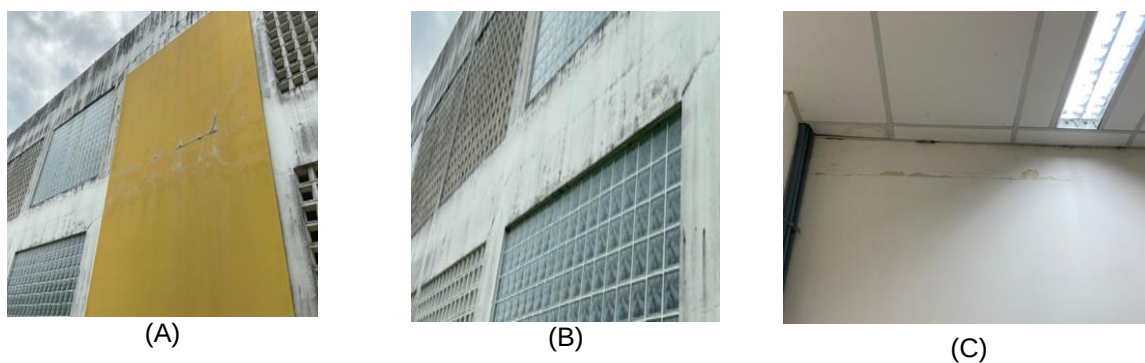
Fissuras na interface alvenaria-pilar nas edificações estudadas.
